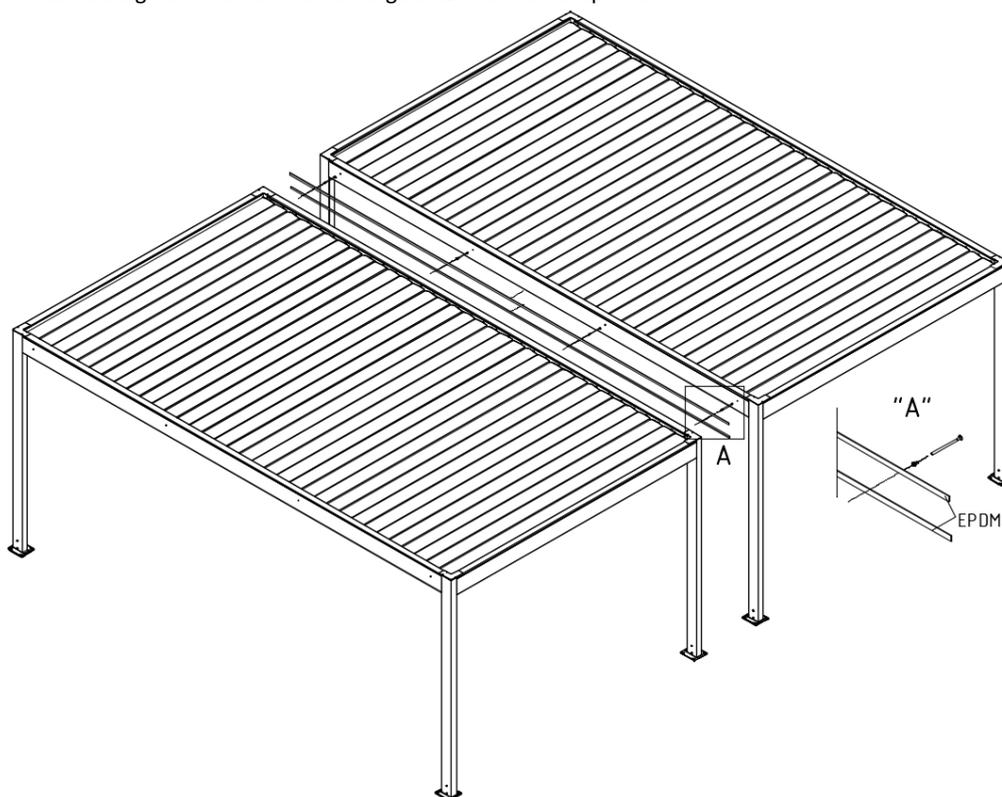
Vue de l'assemblage des modules de la Pergola SB400PRO
